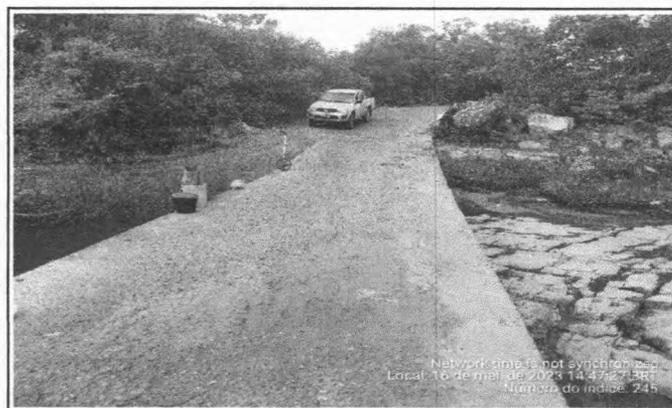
PASSAGEM MOLHADA EXISTENTE
